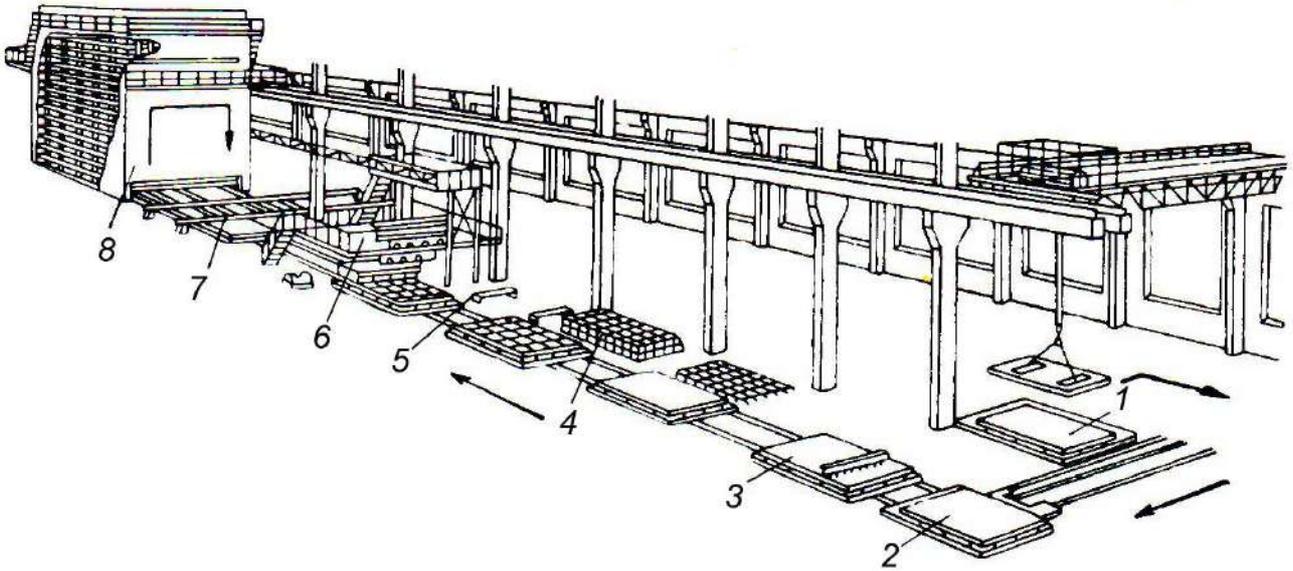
Схема конвейерной вибропрокатной линии производства железобетонных элементов крупнопанельных зданий:
